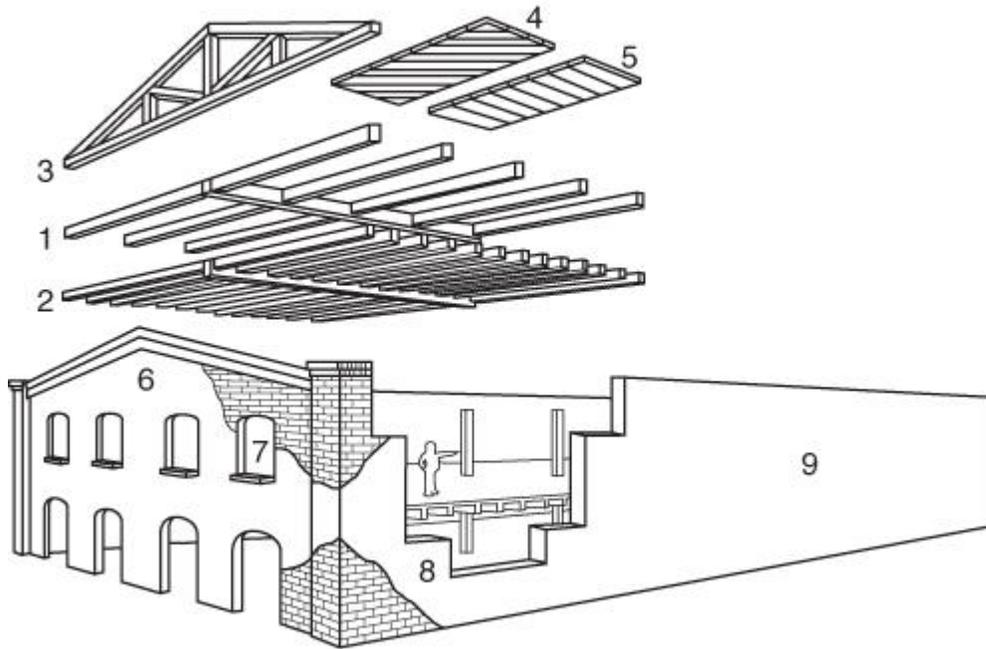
(I) sin refuerzo muro de mampostería, el Ejemplo 1 de 3 rodamiento.
